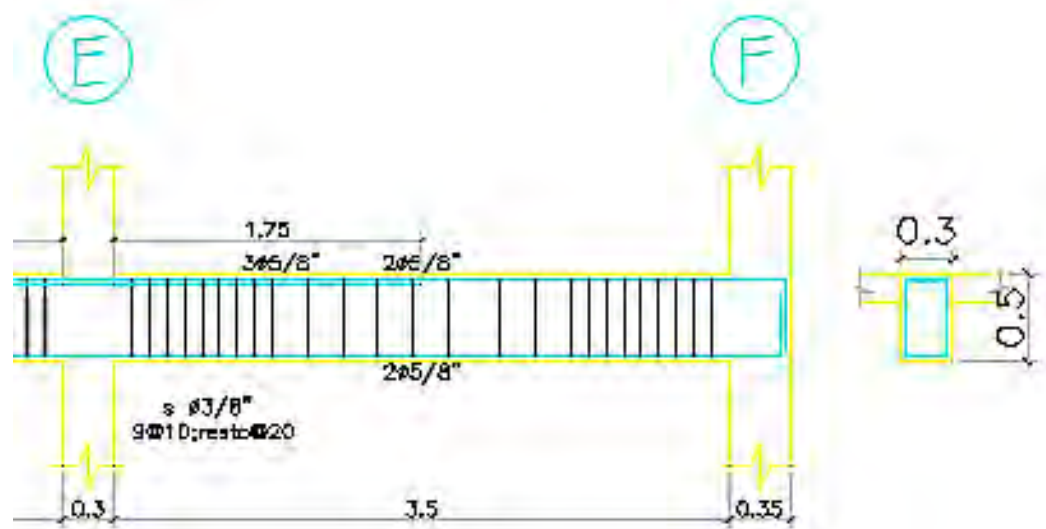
ACERO DE REFUERZO LONGITUDINAL Y TRANSVERSAL - TERCER TRAMO.
